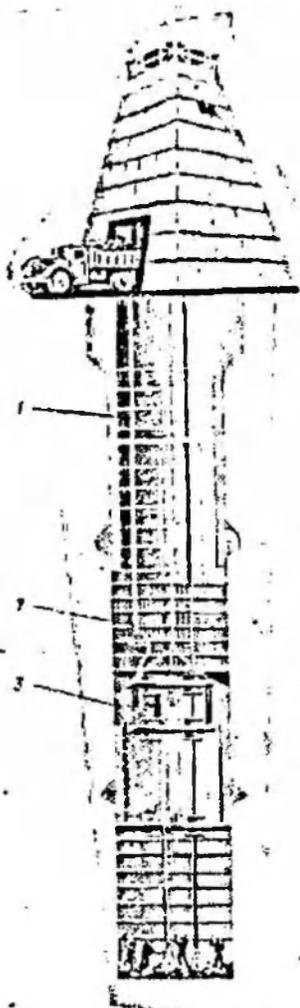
Общий вид оборудования для спуска бетона в ствол по трубам
